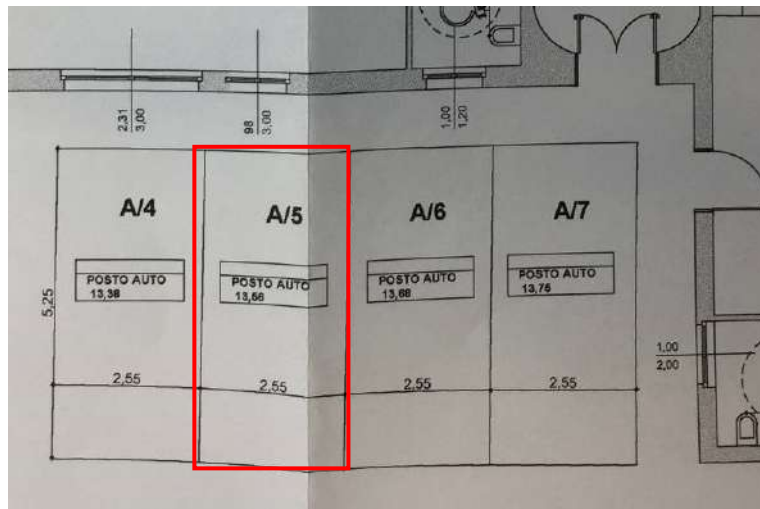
Estratto Tavola 14 allegata alla P.D.C. n. 3675 P.E. 400 del 22.08.2002 - Pianta piano terra
